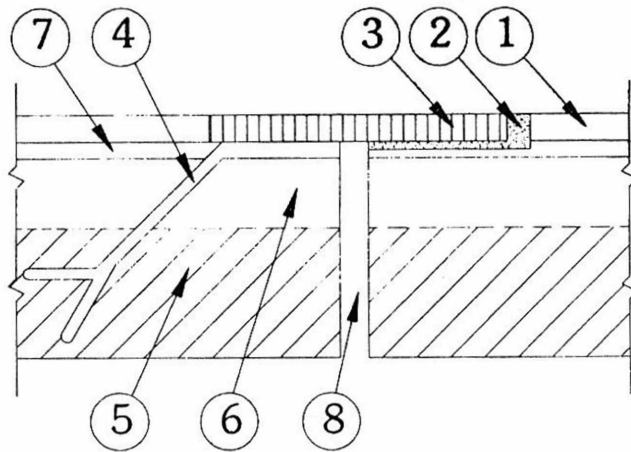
Junta de dilatación, en solados sobre contrapiso y losa de H°A°.
